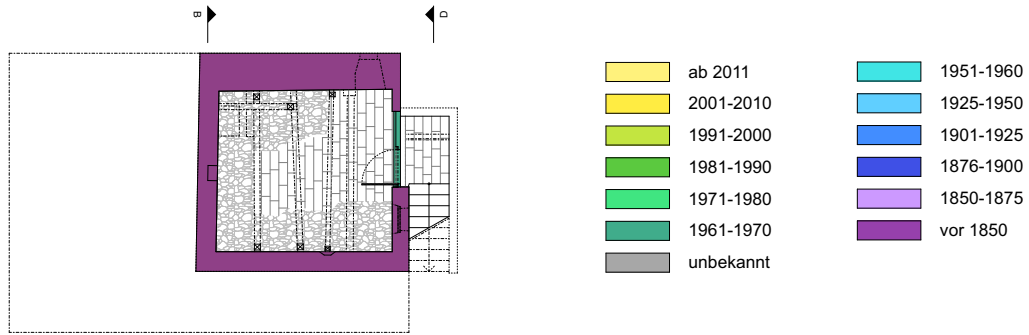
Grundriss UG Bauphasenpläne
